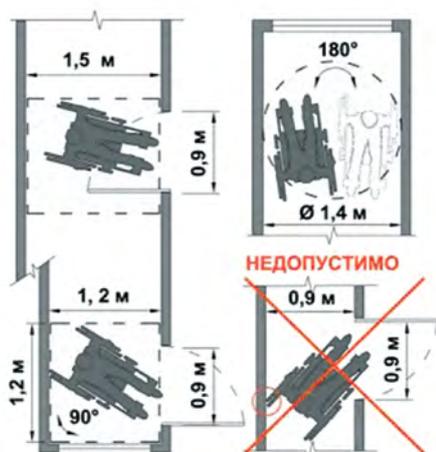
Параметры необходимые для разворота кресла-коляски.
